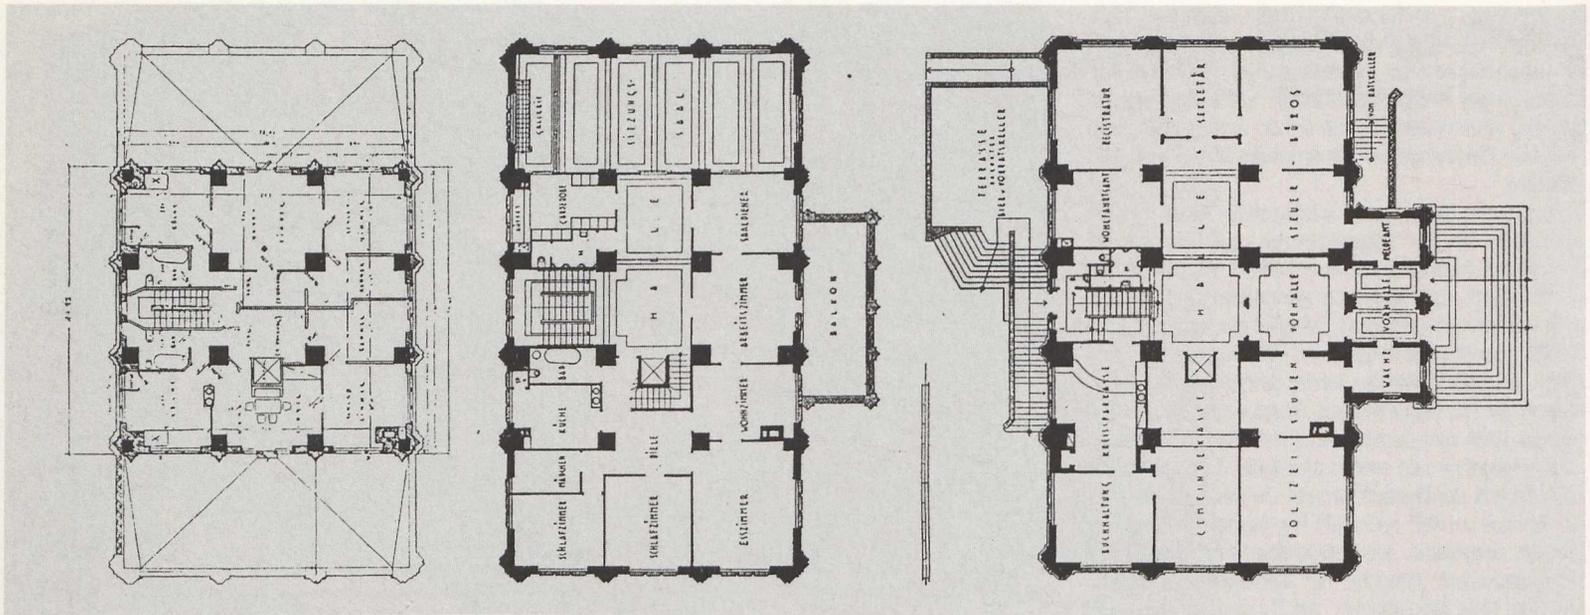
Rathaus Neuenhagen, Grundrisse des 1. Turmgeschosses, des 1. Obergeschosses und des Erdgeschosses, 1925-26
